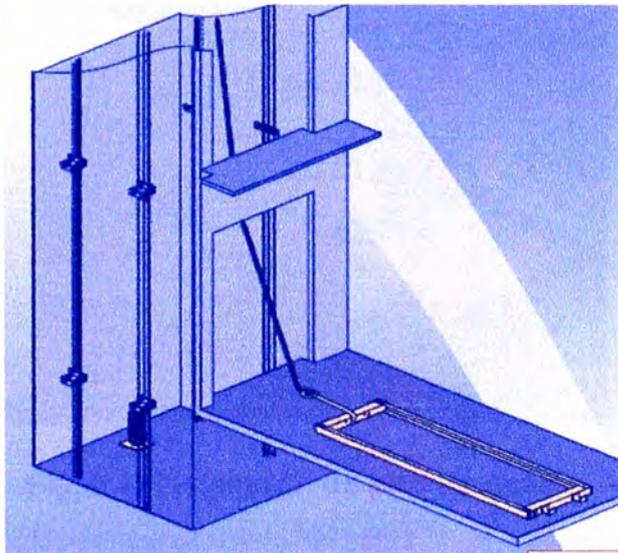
Instalación de estribo de cabina y contrapeso.
